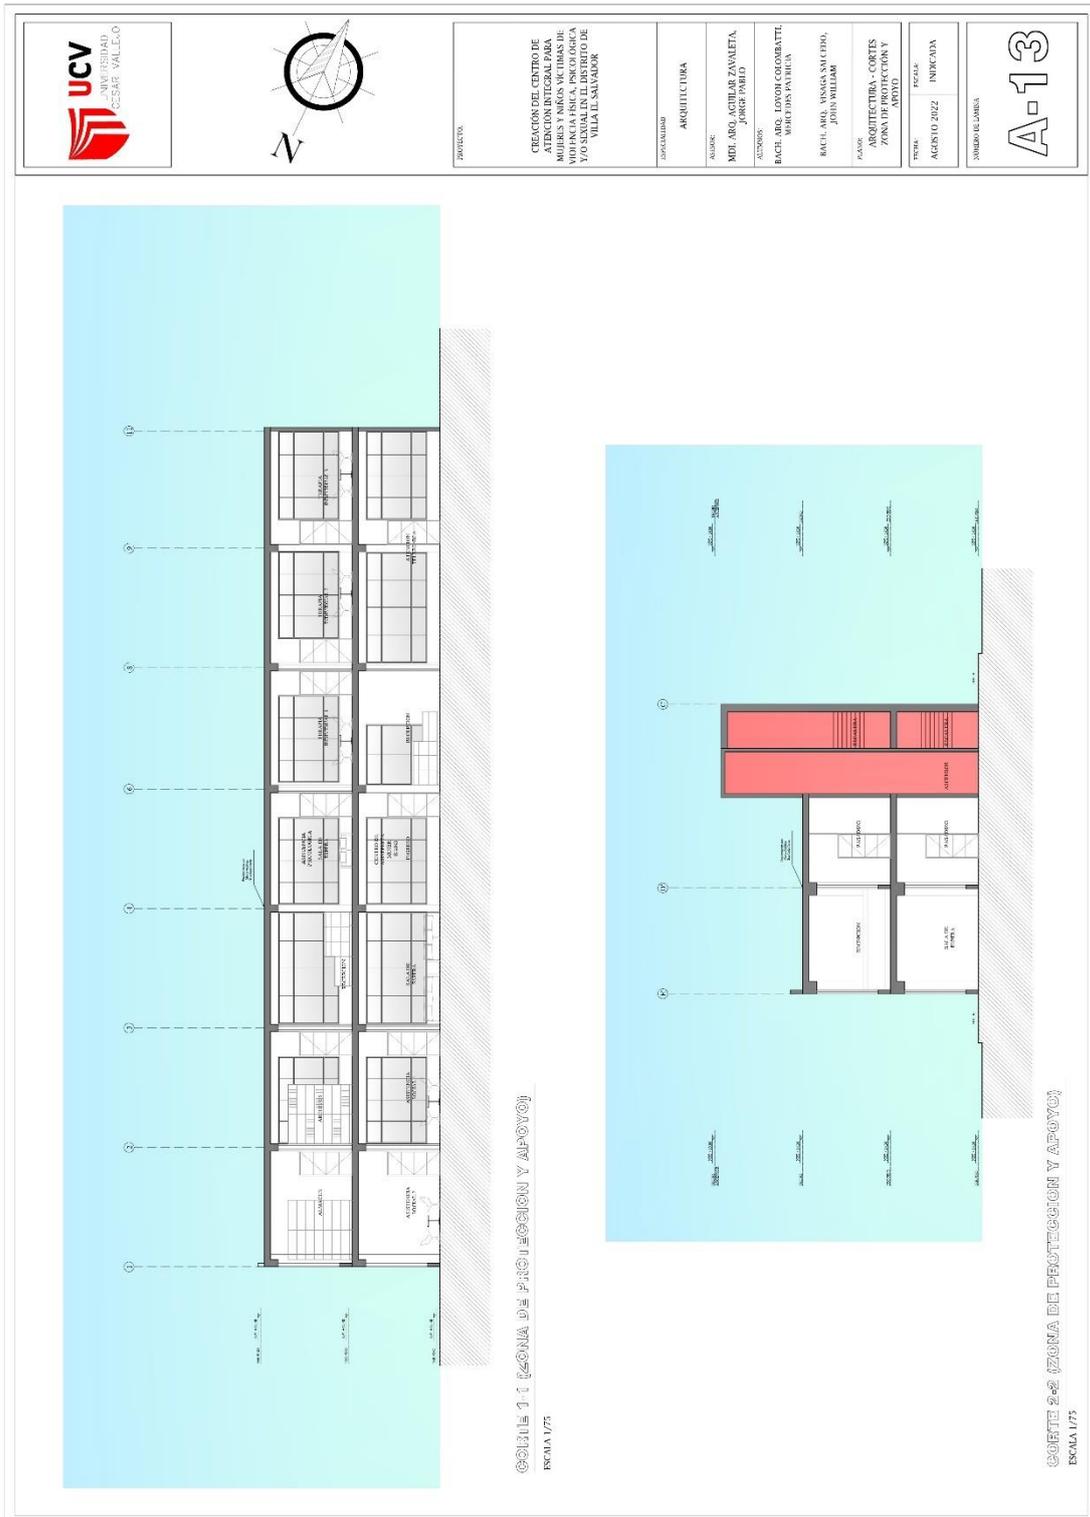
Plano Sector- Zona de Protección y Apoyo - Cortes
